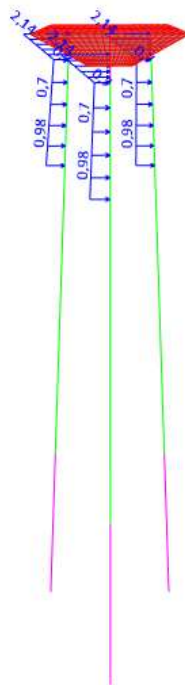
Beban Angin (WZ) yang diterima Struktur *Catwalk 14
